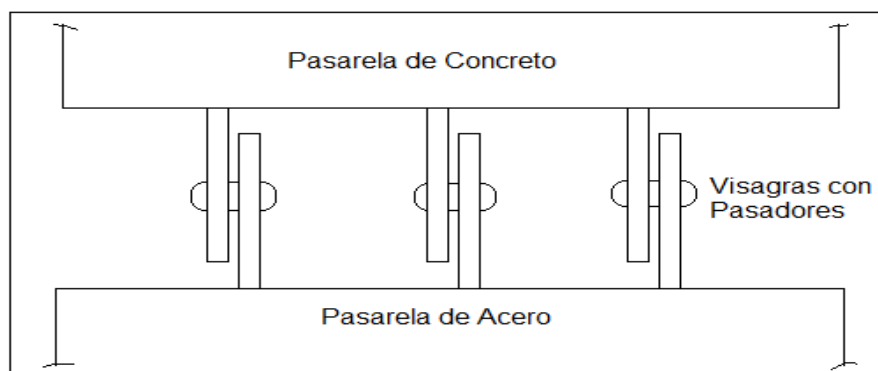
Vista de planta de conexión de pasarela de concreto con pasarela de acceso al muelle
